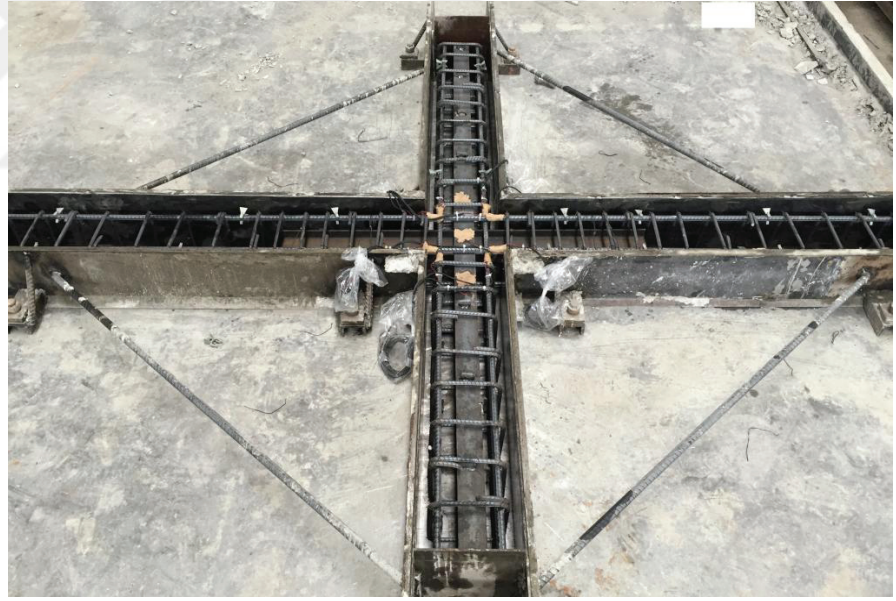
Kompozit kolon – betonarme kiriş birleşim elemanı (F3) kesiti ve donatı planı
